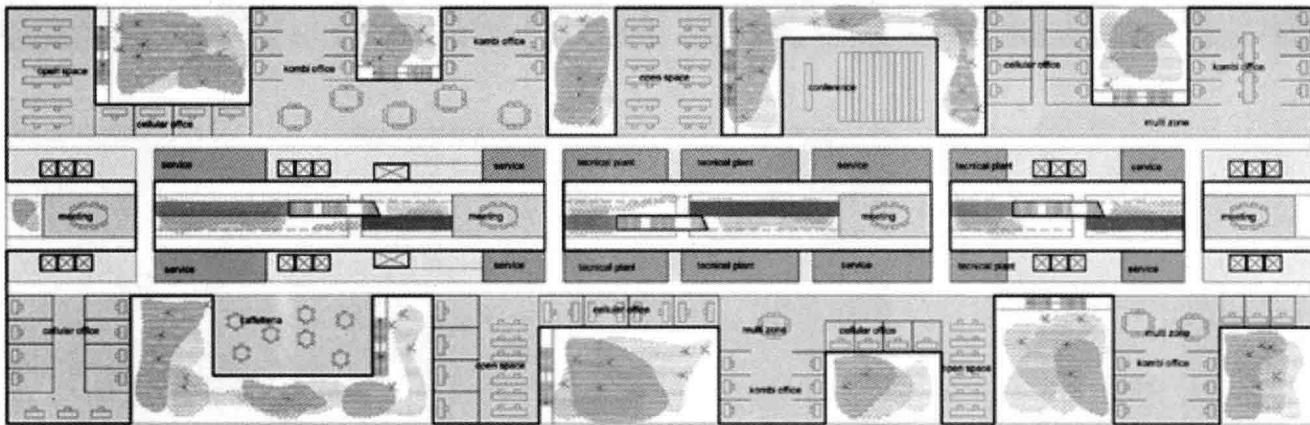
IaN+ 事务所设计的法兰克福 European central Bank 平面图
